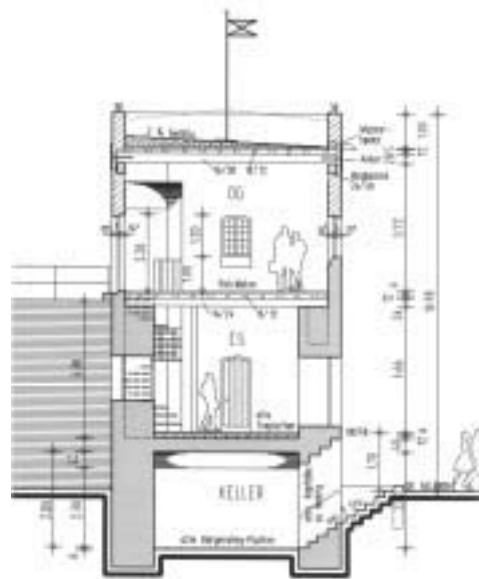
6c. Burgturm. Schnitt und Grundrisse Eingangs- und Obergeschoss. Zeichnung Architekturbüro Karl Amendt
